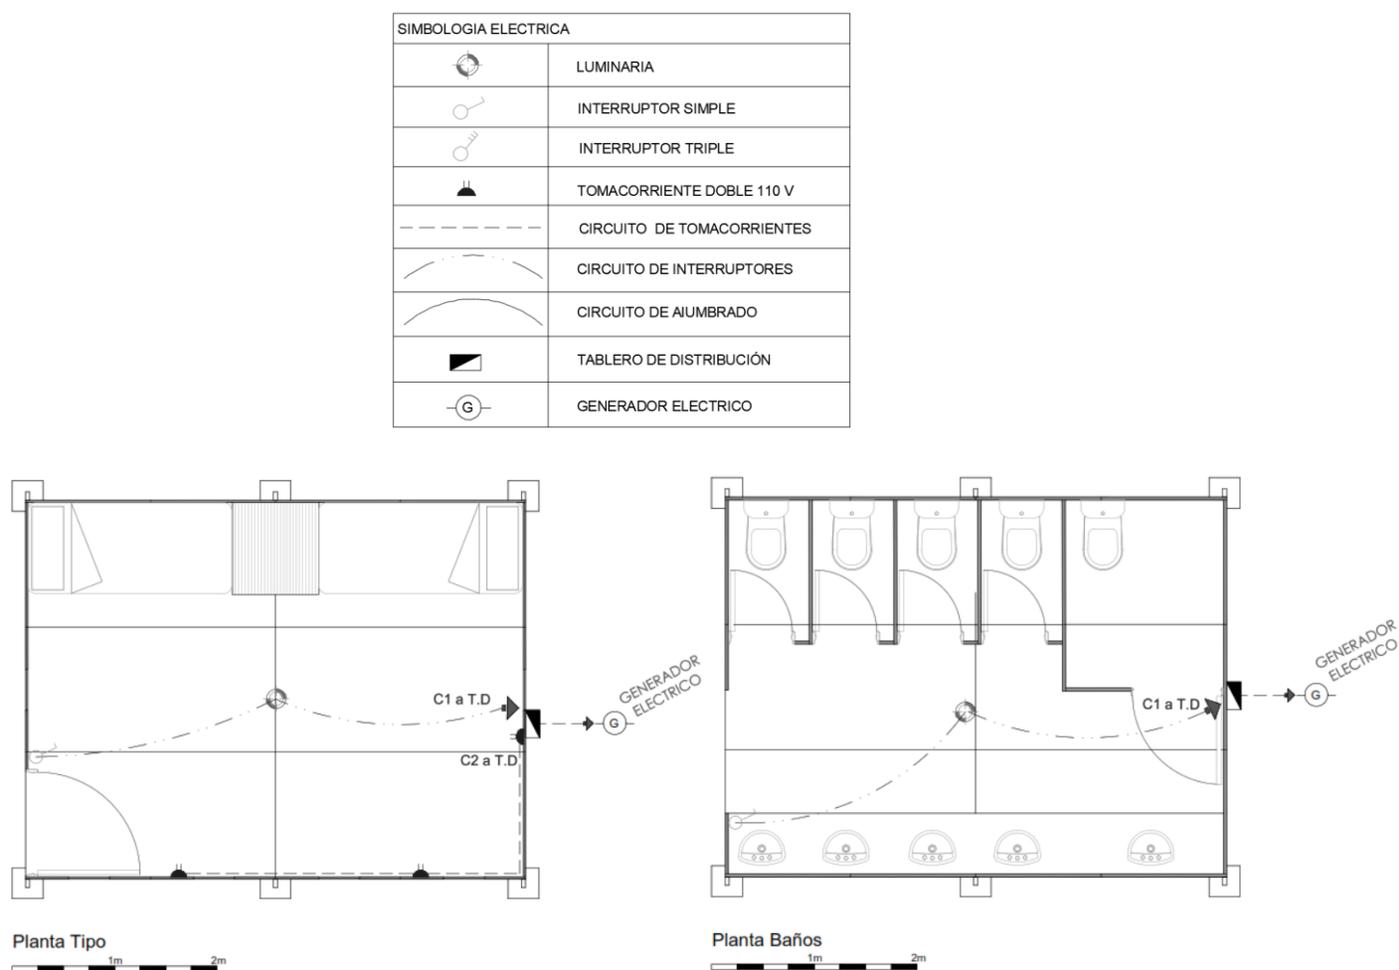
Plantas de instalaciones eléctricas de módulo de vivienda y de módulo de baño
